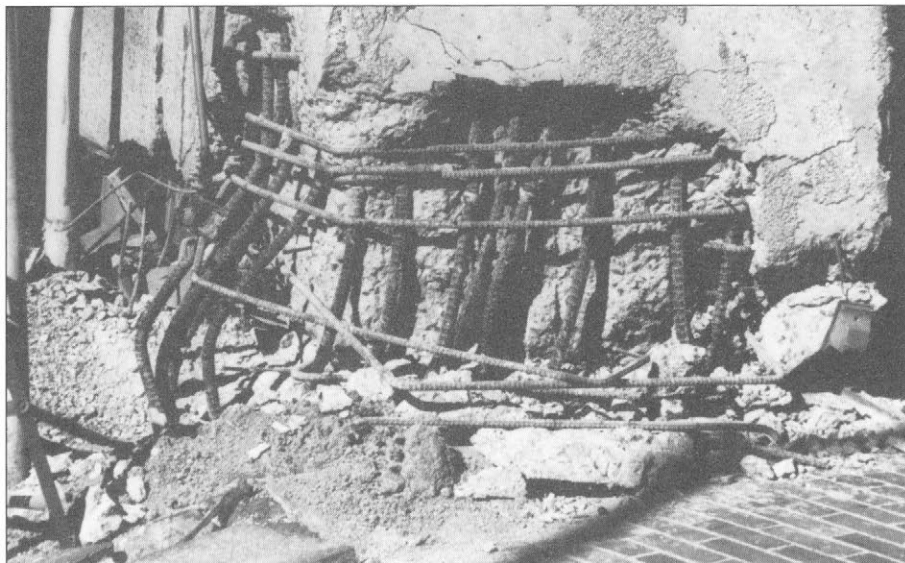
Armiranobetonska stanovanjska stavba se je nagnila zaradi porušitve mehkega pritličja
